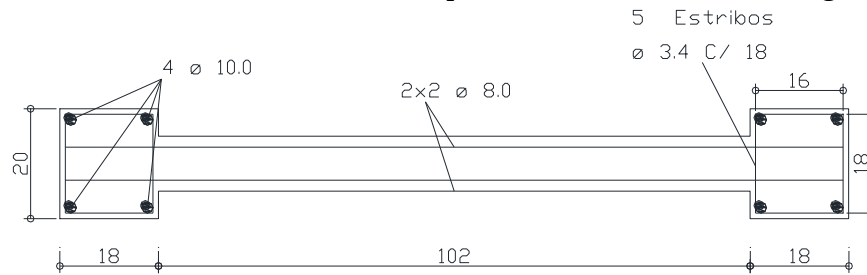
Viga B1 – dimensões em centímetros (Guimarães, 1980).
